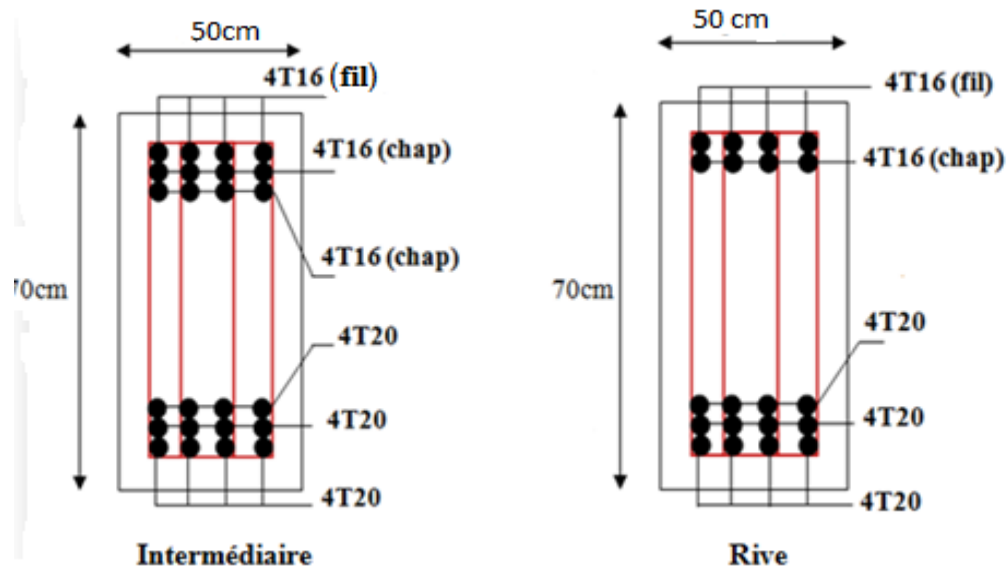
Ferrailage de la poutre de libage suivant le sens longitudinal.
